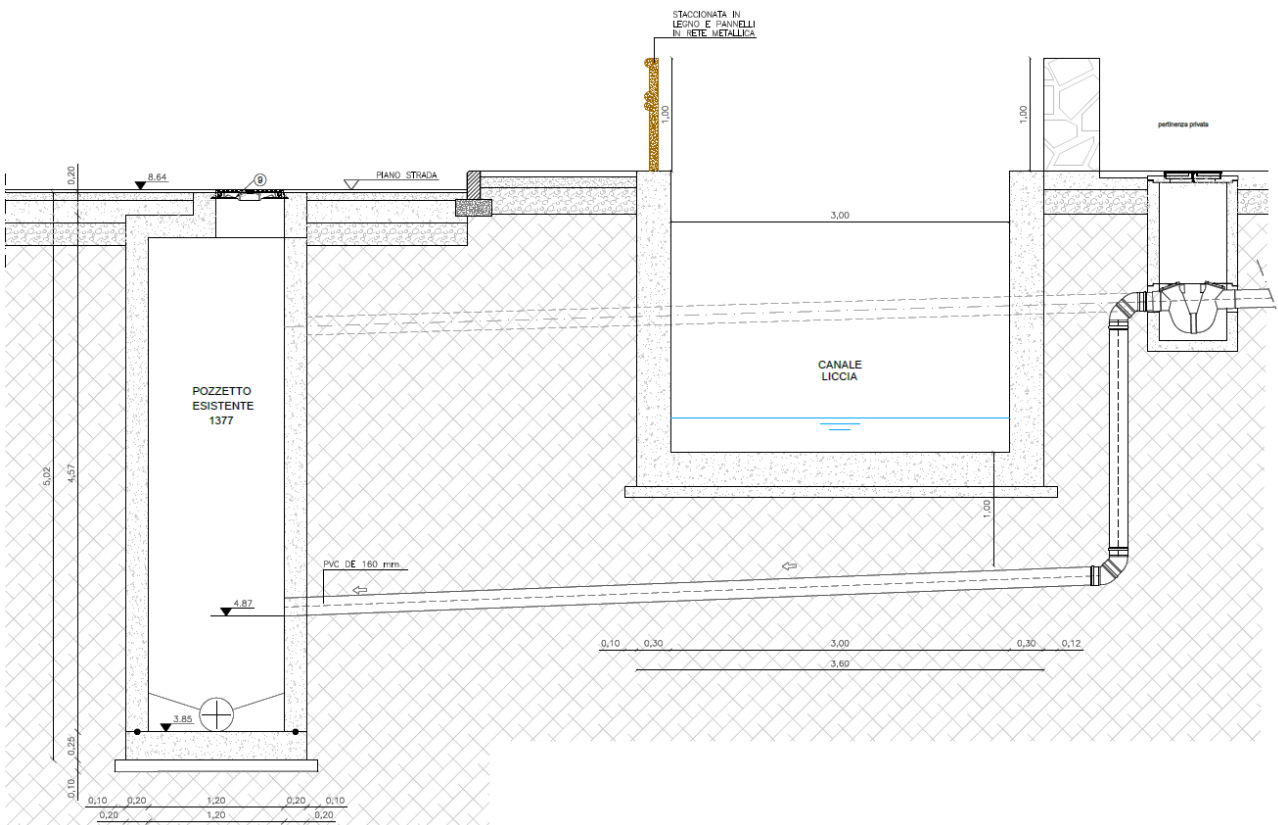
Particolari risoluzione interferenza n. 1 - Particolare allaccio su pozzetto P1377
